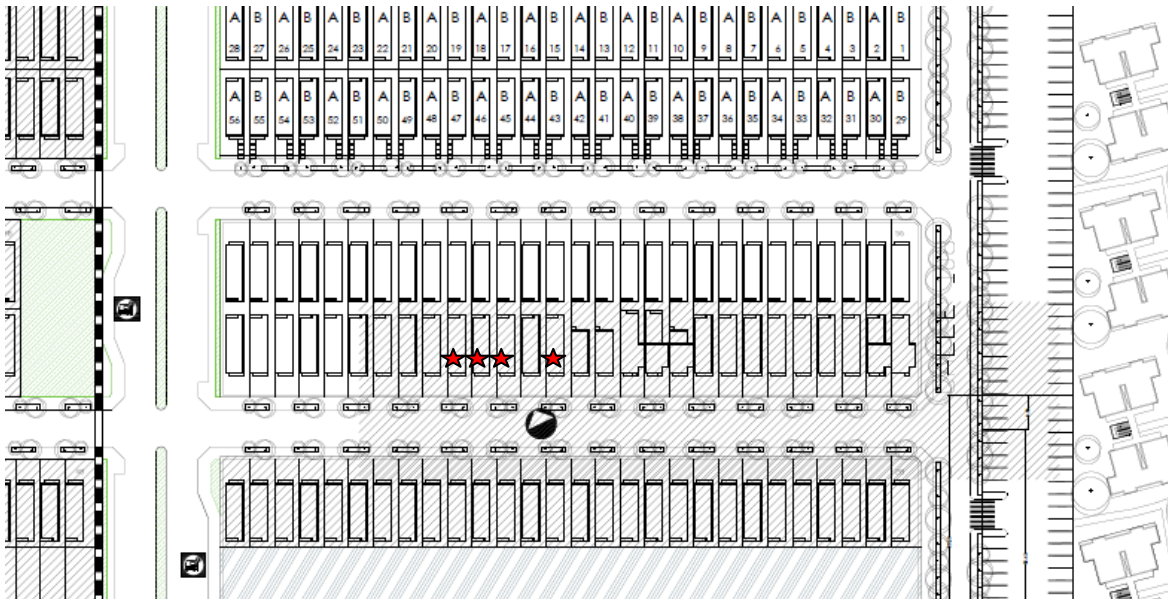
Fracción del plan urbano de Caucel con casas del experimento indicado
